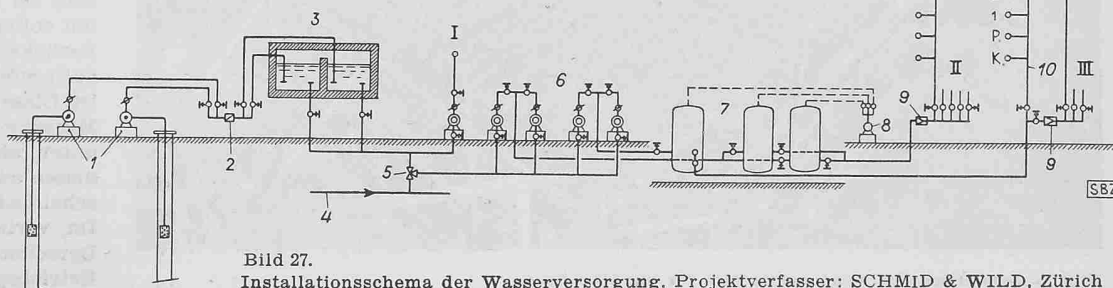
Installationsschema der Wasserversorgung. Projektverfasser: SCHMID & WILD, Zürich
